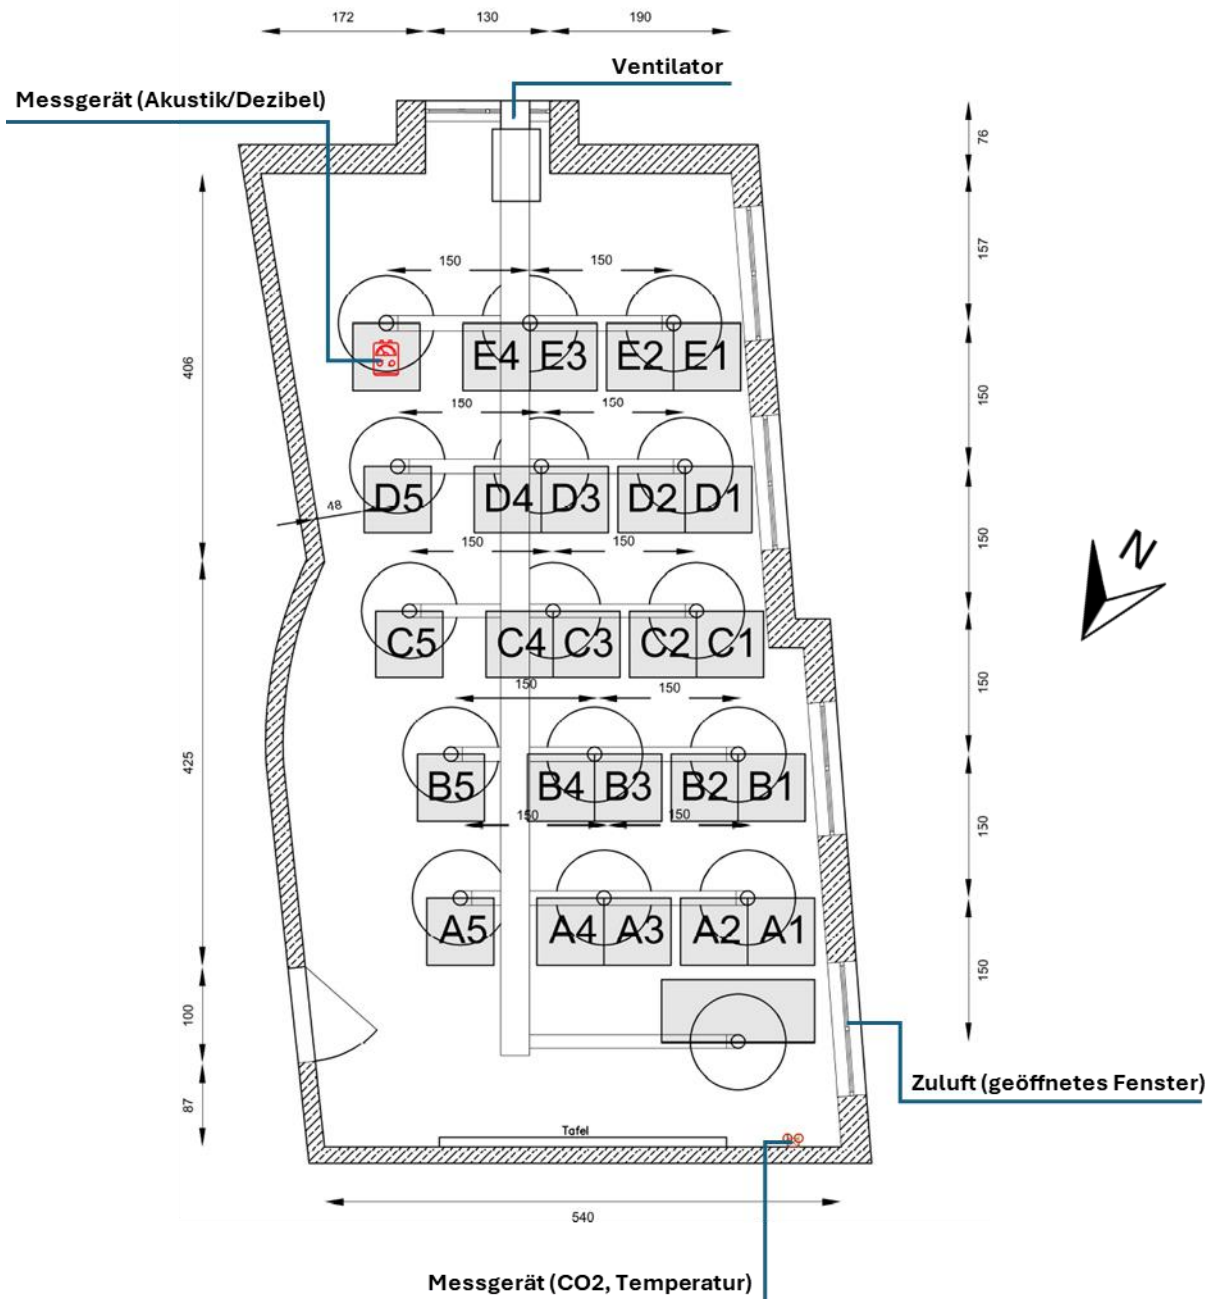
Klassenraum 7.C, Grundrissplan [adaptiert von 23]
